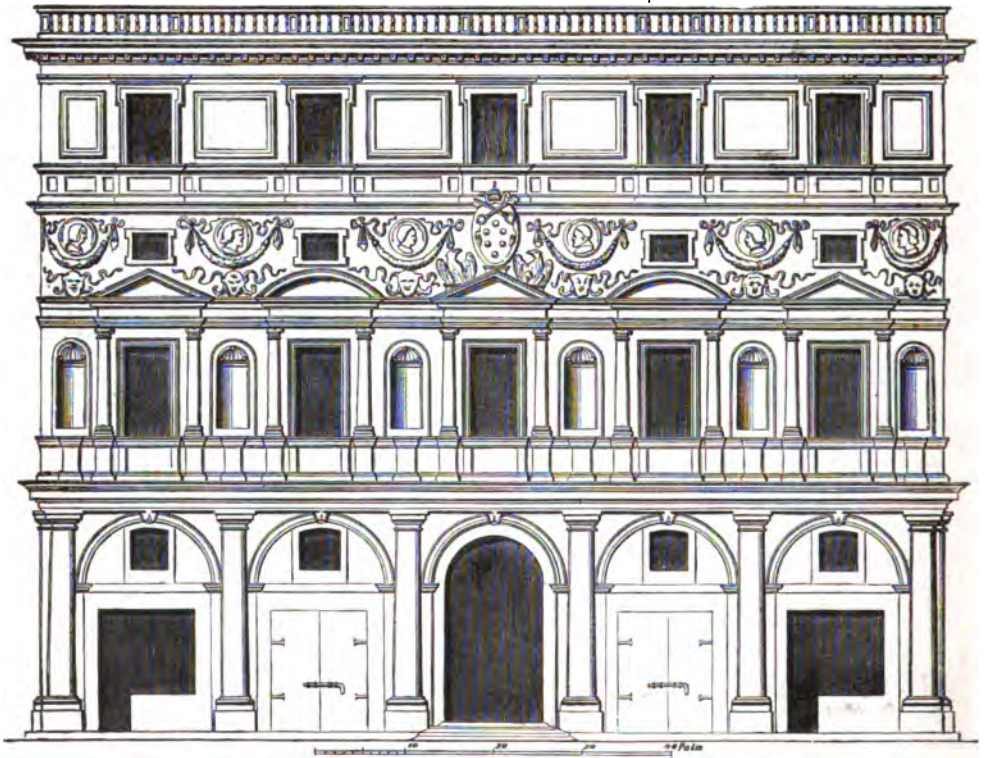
Façade des ehemaligen Pal. dall' Aquila.
